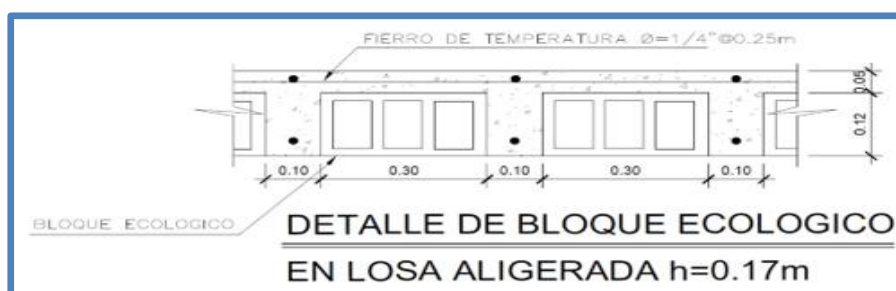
Detalle de bloque ecológico en losa aligerada.
